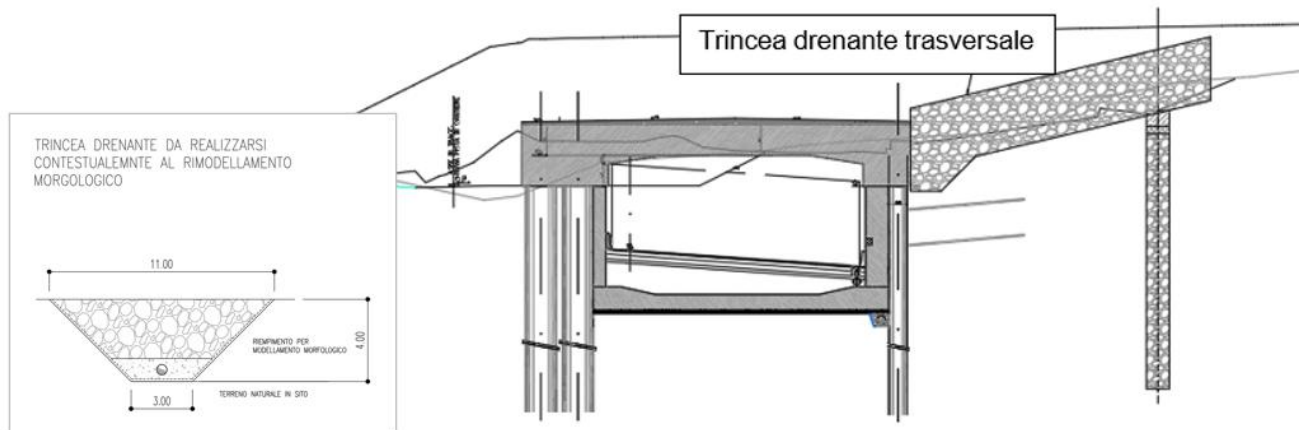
Sezione in corrispondenza trincee drenanti trasversali
